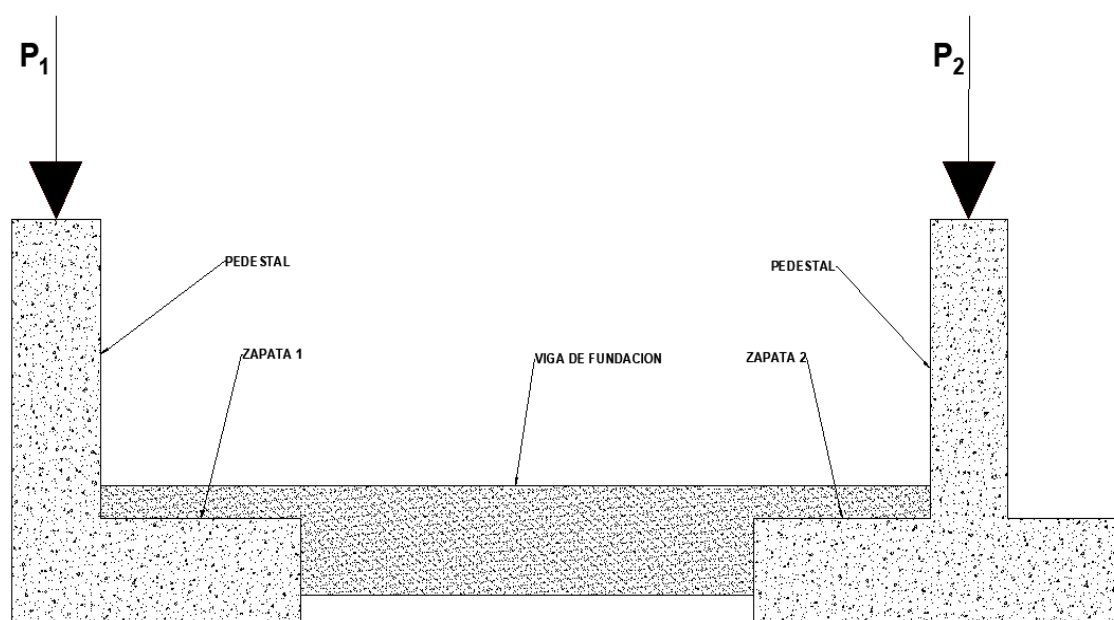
28 Zapatas conectadas mediante viga de fundación.
